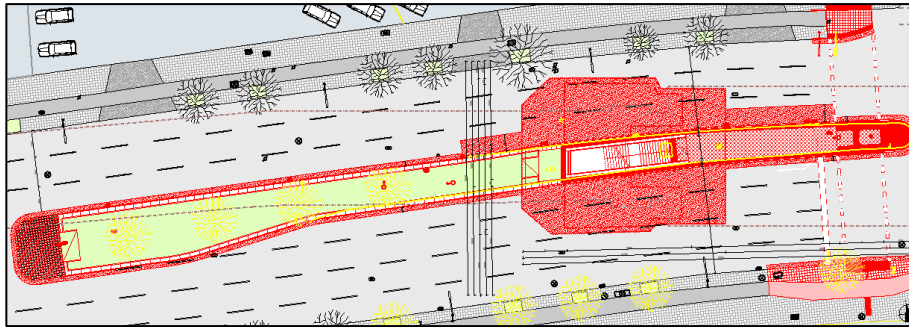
Ausschnitt Plan Zi\_PG 2.1a Entwurf Straßenebene (unmaßstäblich)
